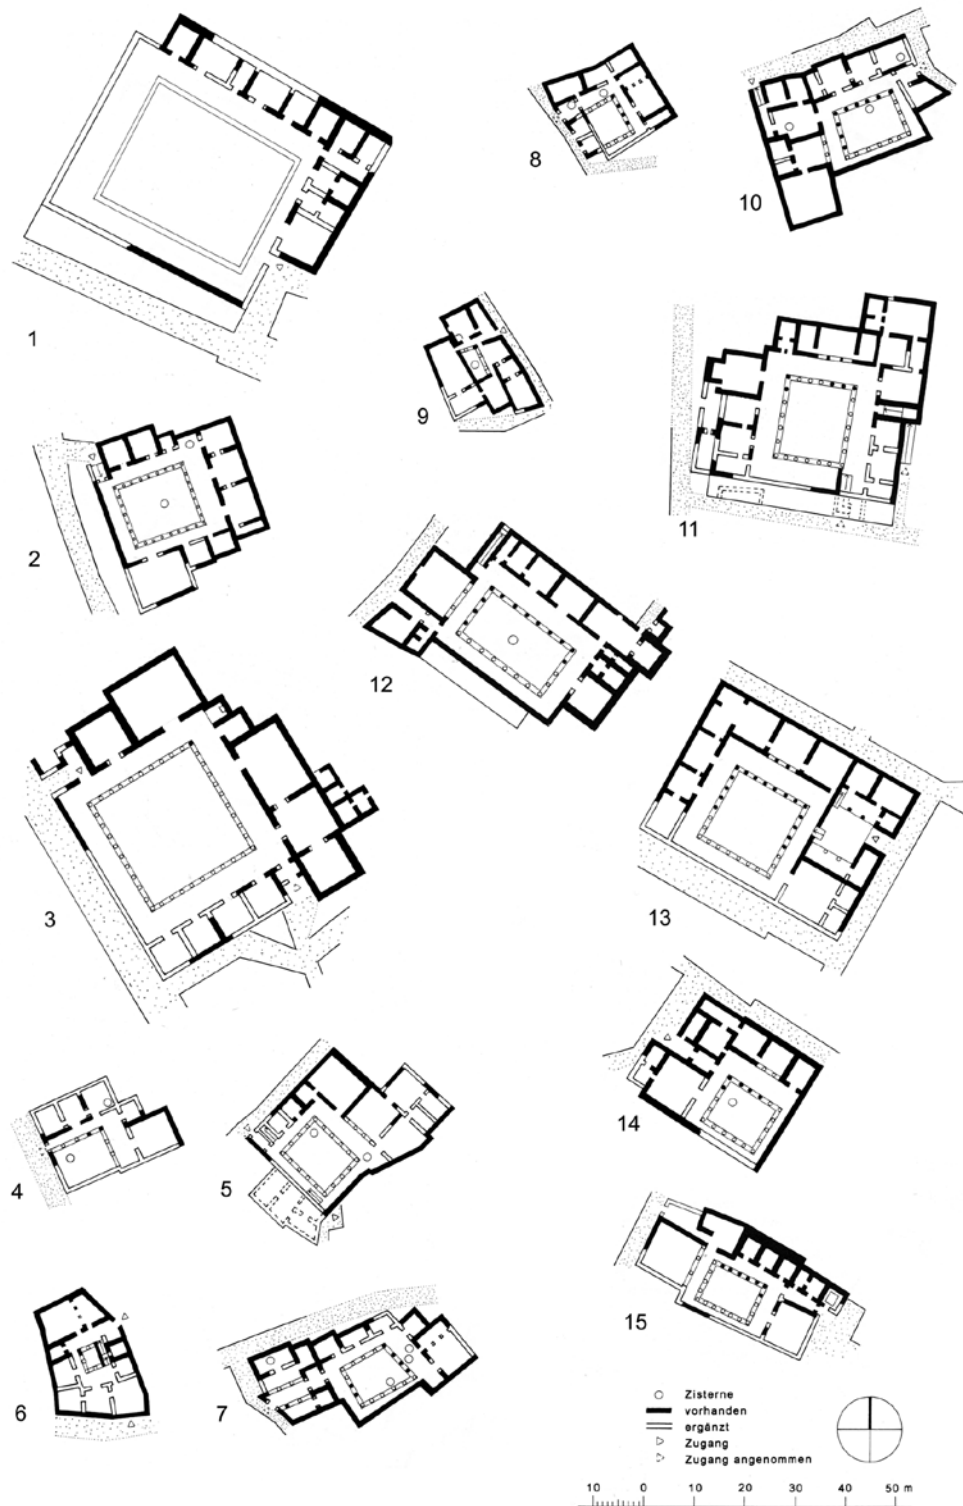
Grundrisse der Peristylhäuser von Pergamon: 1 Palast I. 2 Palast IV. 3 Palast V. 4 Haus südöstlich des Temenos für den Herrscherkult. 5 Stadtgrabung, Großes Peristylhaus (Komplex VII). 6 Stadtgrabung, Kleines Peristylhaus (Komplex X). 7 Stadtgrabung, Haus nördlich des Hestia-Heiligtums. 8 Stadtgrabung, Haus unter dem Hestia-Heiligtum. 9 Stadtgrabung, Kleines Peristylhaus westlich der Gasse. 10 Stadtgrabung, Großes Peristylhaus westlich der Gasse. 11 Stadtgrabung, Bau Z (Hauptphase). 12 Attaloshaus. 13 Westlich der Unteren Agora, Haus I. 14 Westlich der Unteren Agora, Haus II. 15 Westlich der Unteren Agora, Haus III
